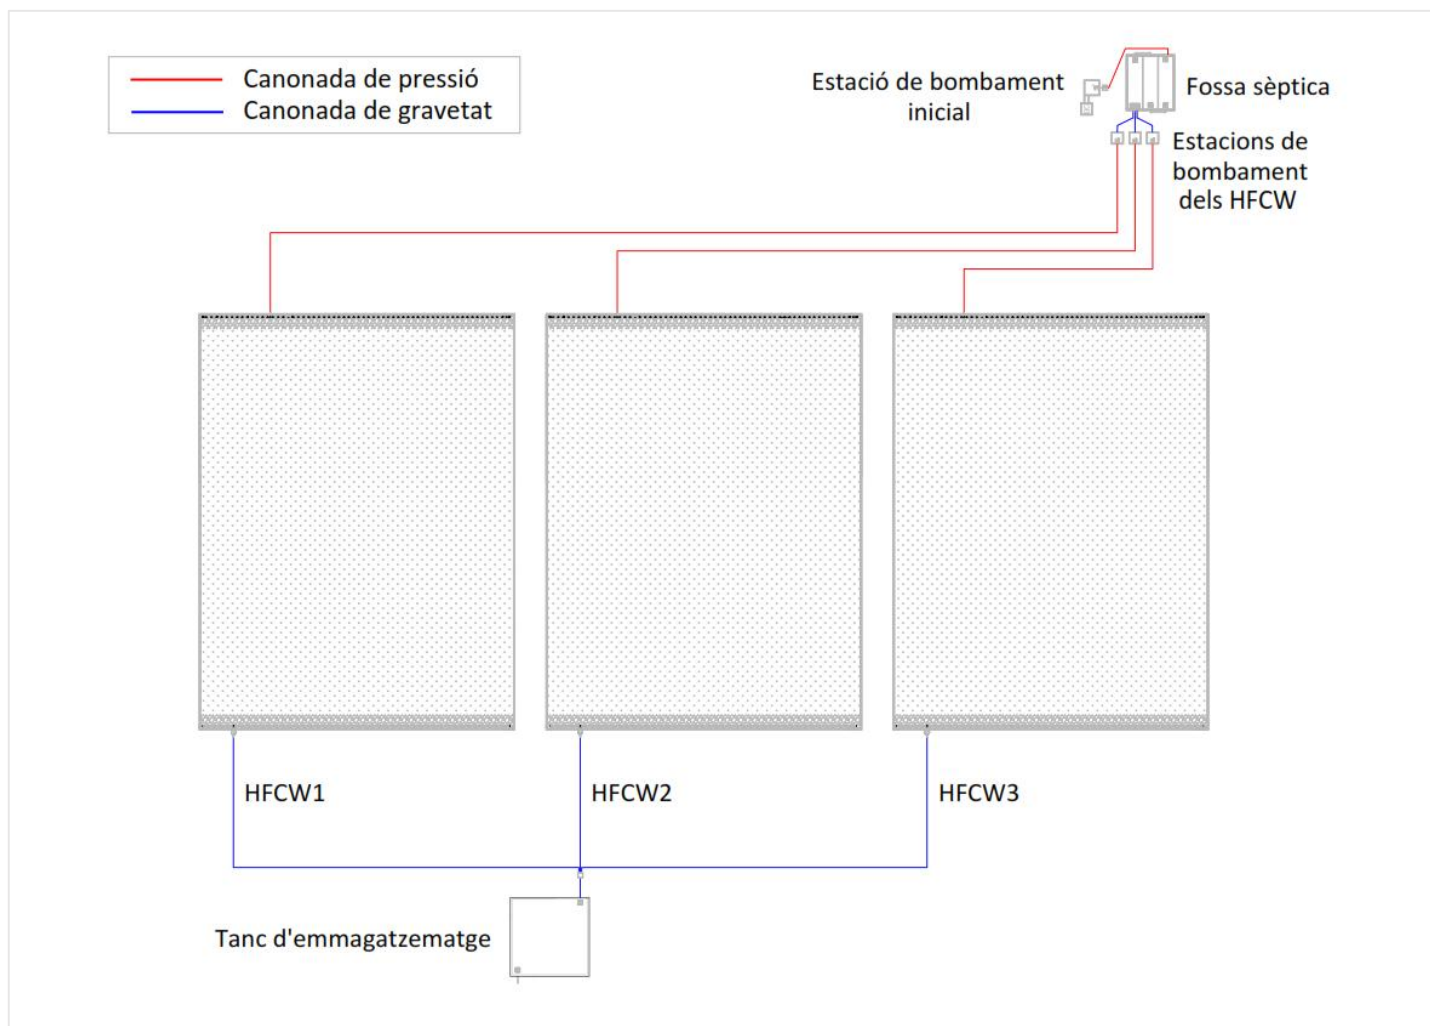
Exemple de la planta general del sistema d'HFCW sense MFC.
